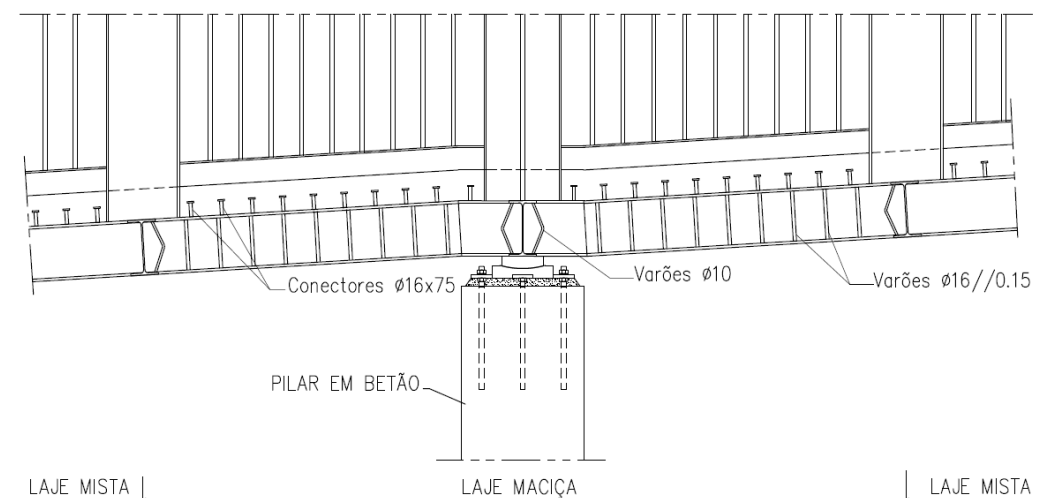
Corte longitudinal da estrutura metálica junto ao pilar P1 [2]
